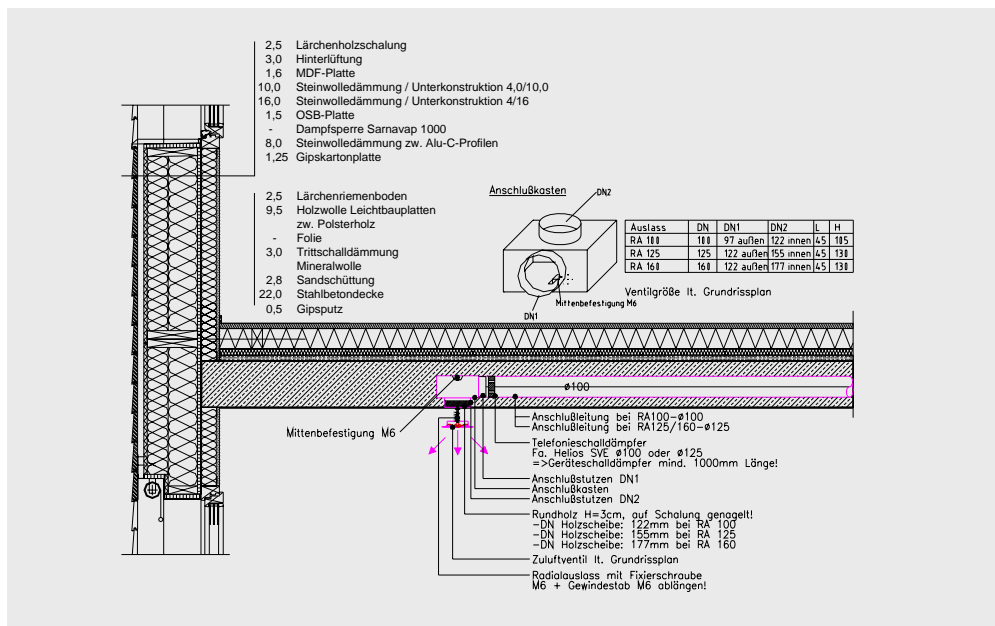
Auszug Kriterienkatalog, HLSE - Detail L_41_GD_37, weitere Details siehe Anhang 16.4
